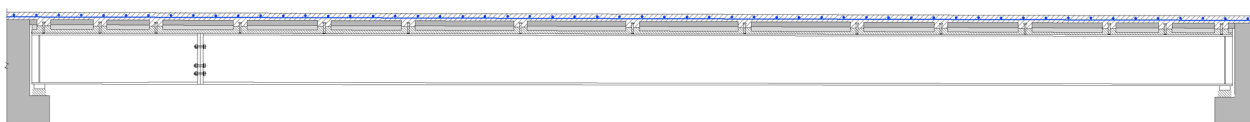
Alzado tipo de nueva viga metálica de refuerzo conectada a la estructura existente
